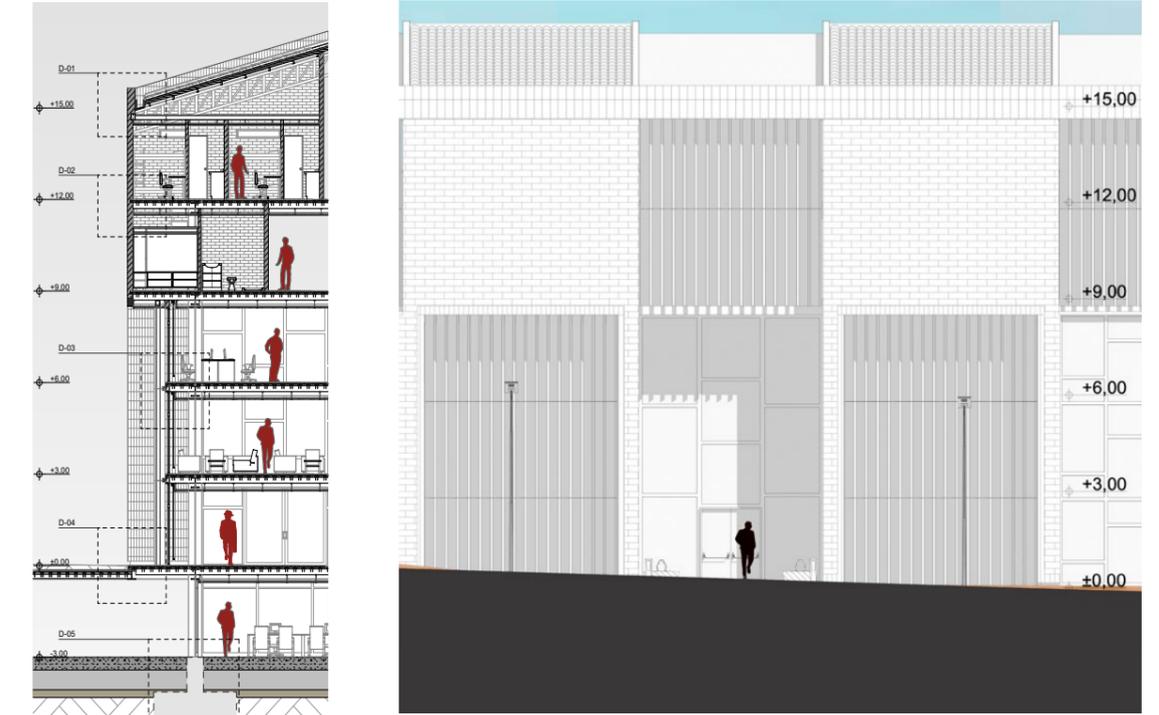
Sección constructiva y alzado Gráfico: Elaboración propia
